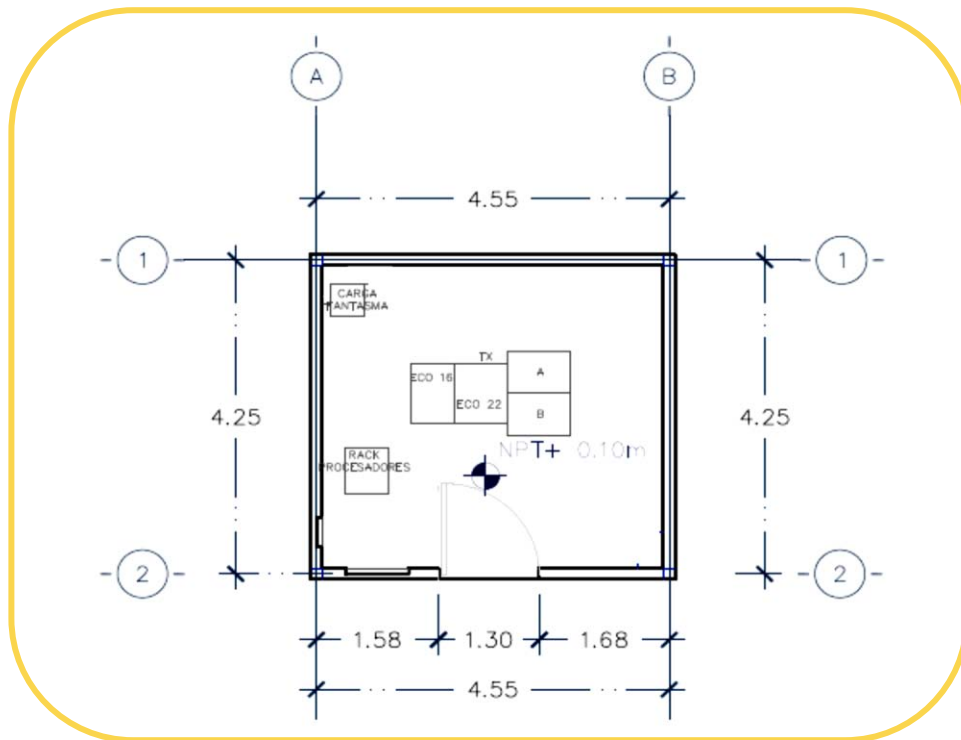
Planta Arquitectónica del Sitio de Transmisores de Radio.
